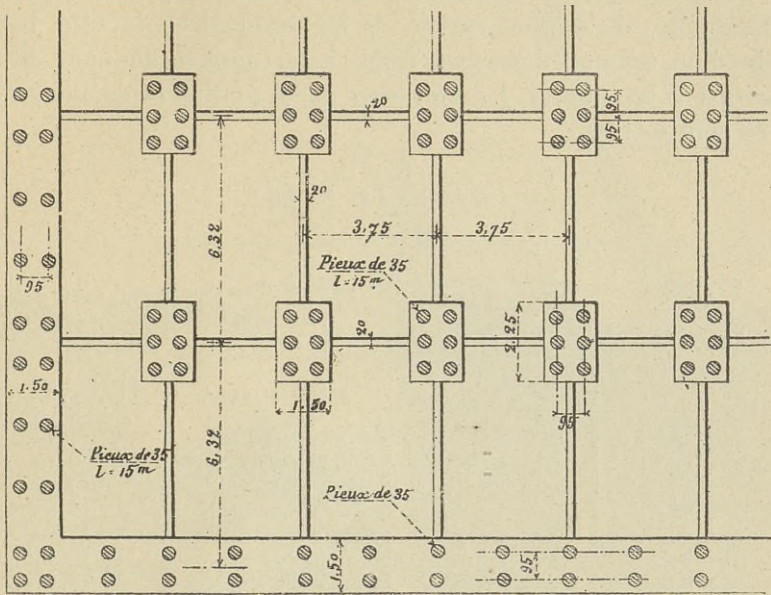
Disposition des pieux et des semelles de fondation d'un entrepôt.
